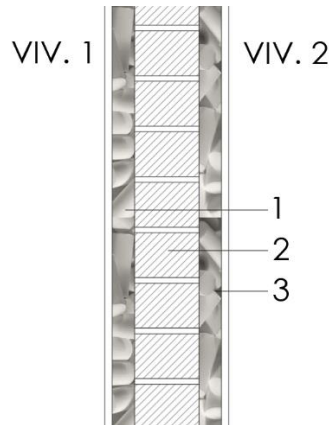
Detalle de tabiquería de división entre viviendas (sección vertical) con aislante de filtros en Málaga. Fuente: Elaboración propia
